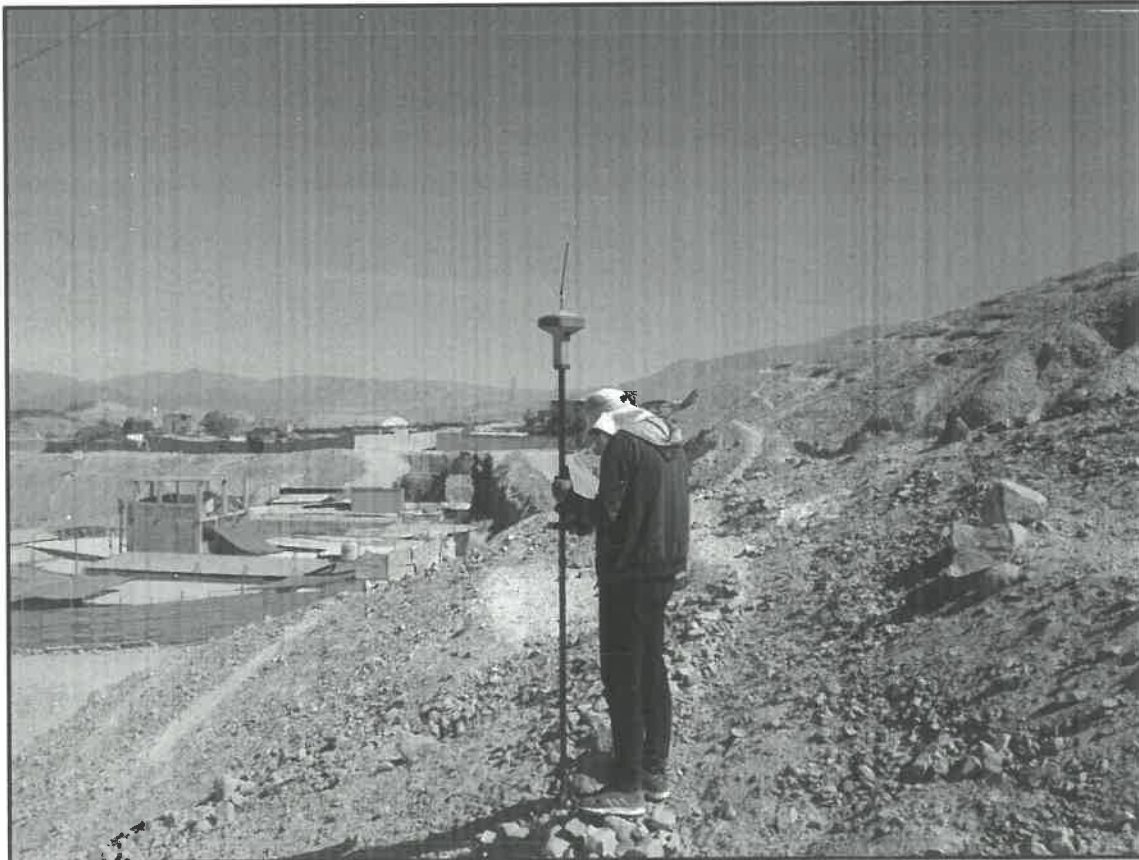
Levantamiento topográfico de zonas accidentadas - laderas.
